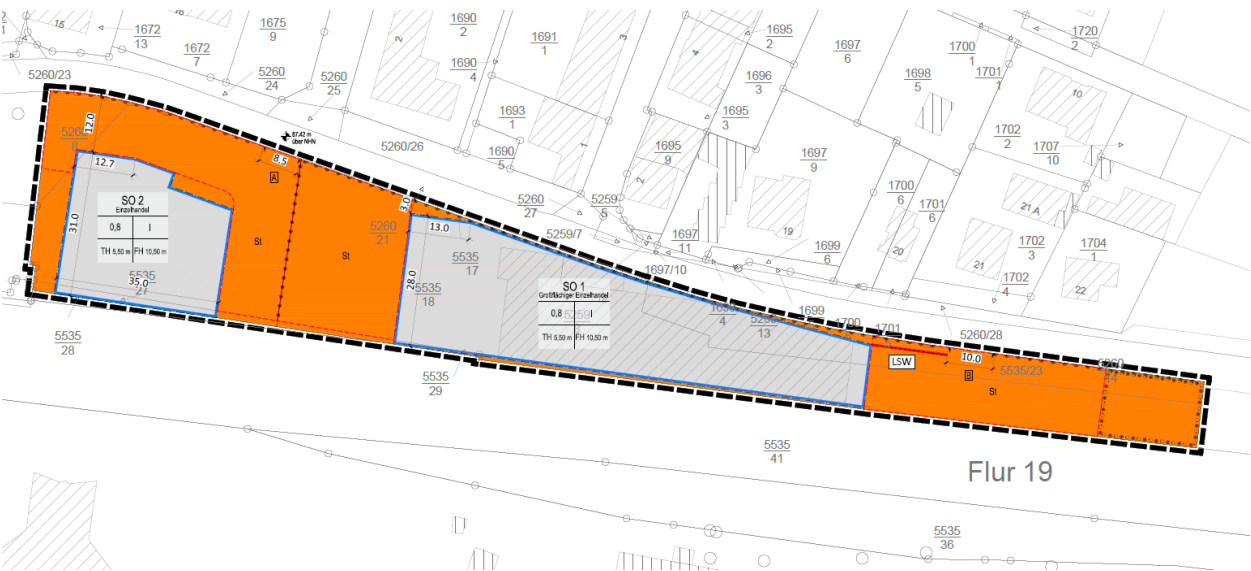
Entwurf des Bebauungsplans „Bahnhofstraße, 5. Änderung“
